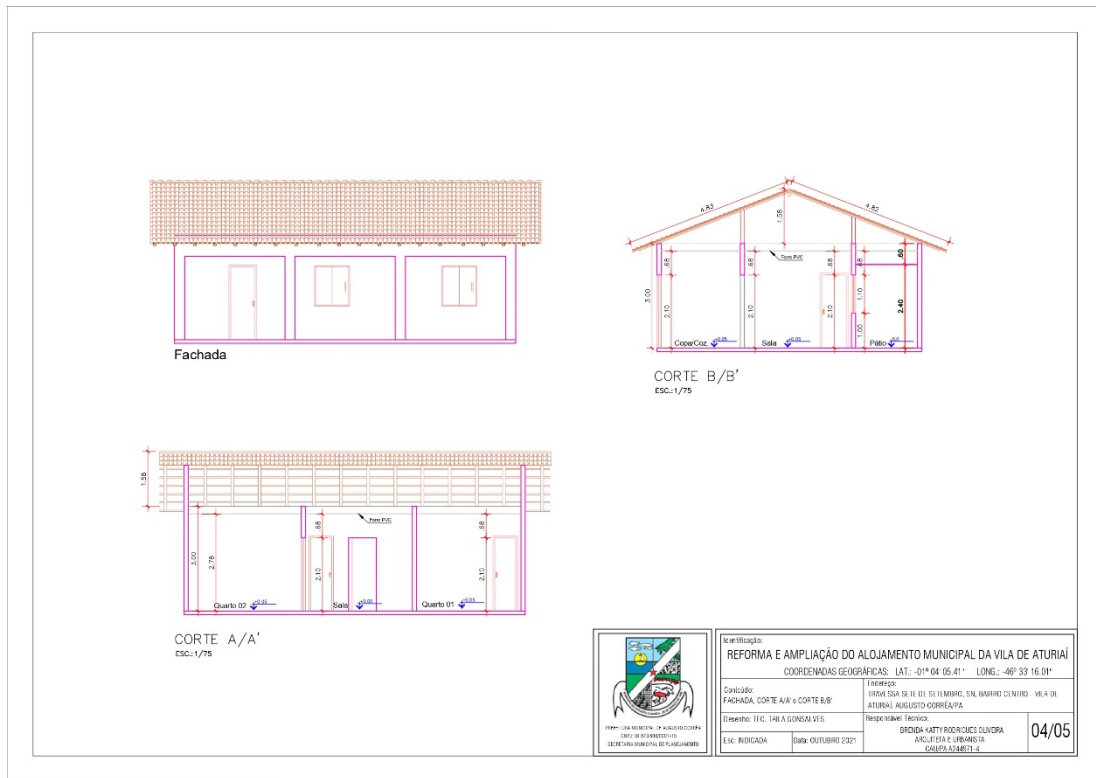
Fachada, Corte A/A' e Corte B/B'.
